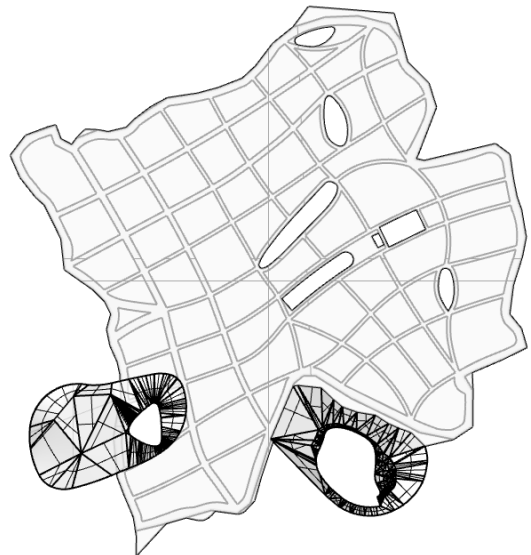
Geometría en planta de las vigas del forjado de planta baja.
